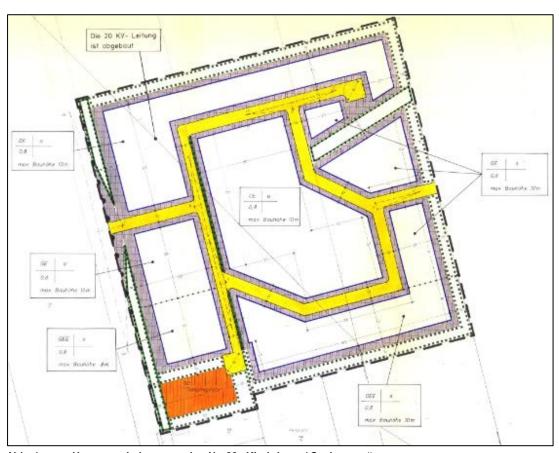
Ursprungsbebauungsplan Nr. 28 "Kirchdamm/ Seehausen"
